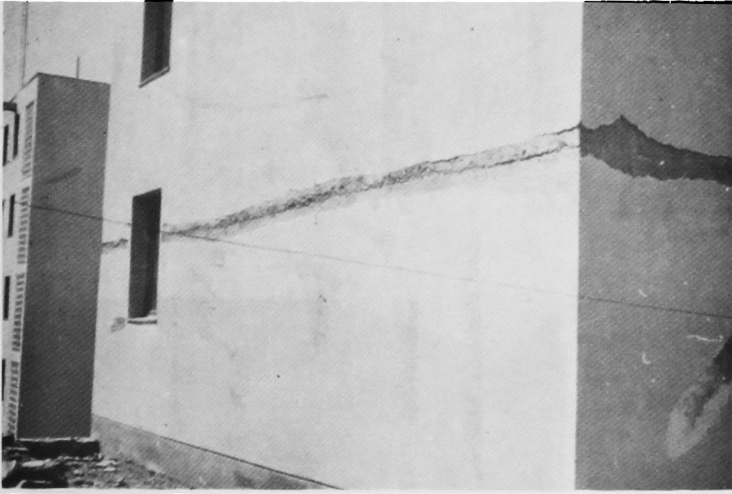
Detalle de grieta en junta de hormigonado. Edificio de Carabineros.
